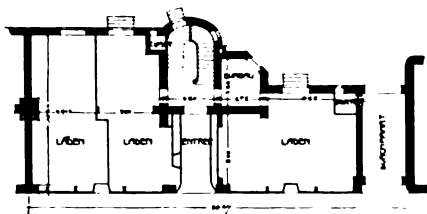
Blumenstrasse 7. Erdgeschoss.
